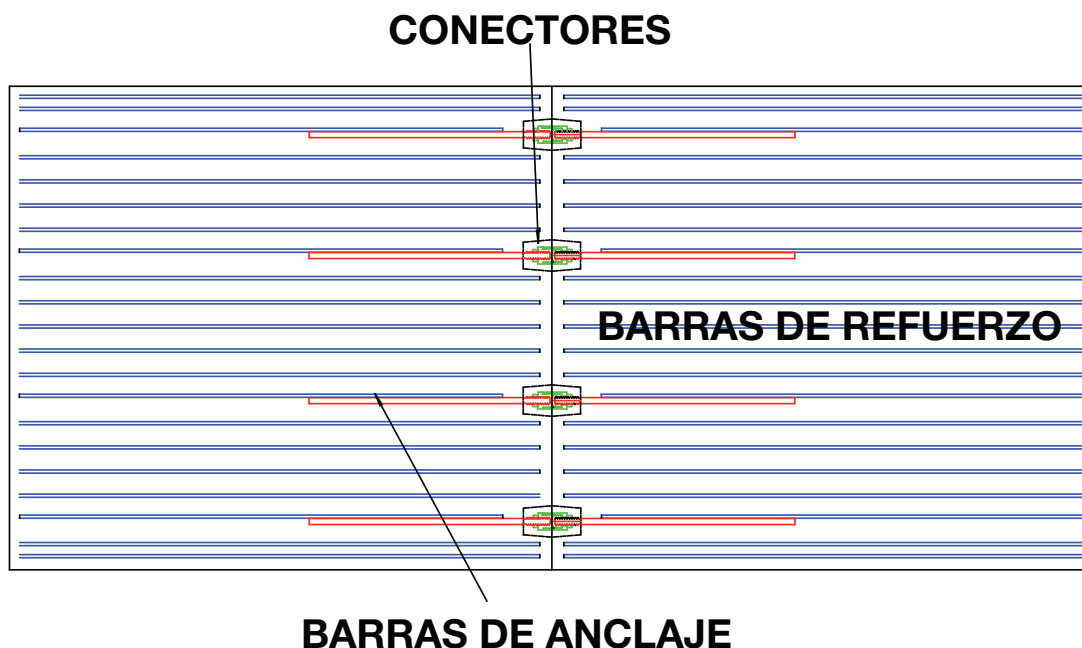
Vigas Pre-fabricadas: Distribución de Acero de refuerzo y Sistemas de Anclaje.
